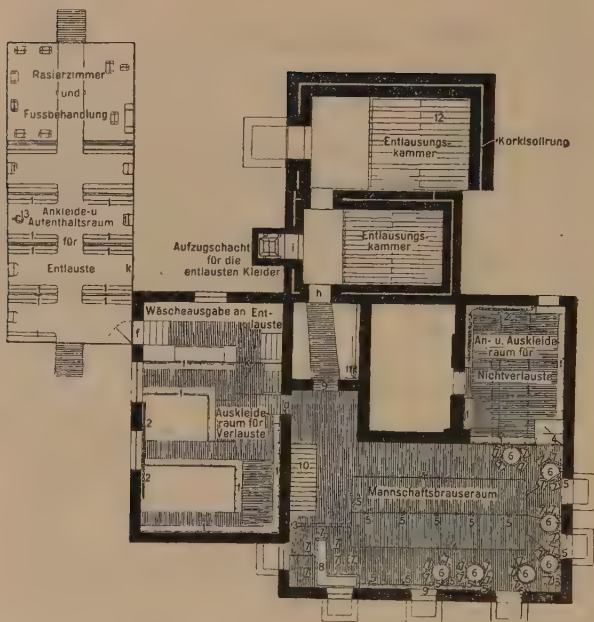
Plan C. Hauptgebäude, Grundriß, Kellergeschoß.
